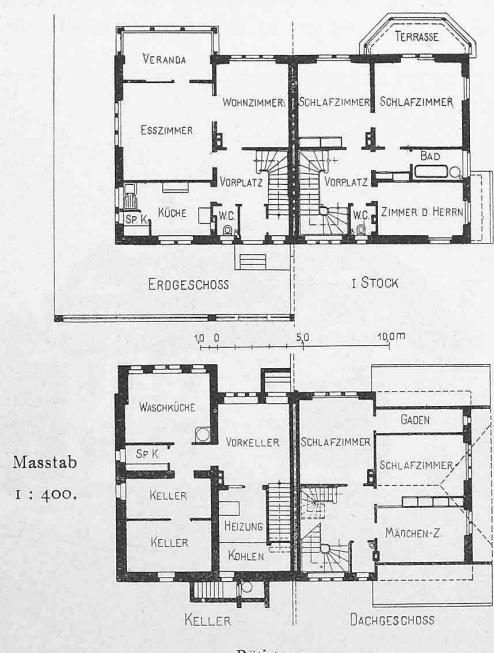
Grundrisse der Doppelvilla an der Rütistrasse in Zürich V.
